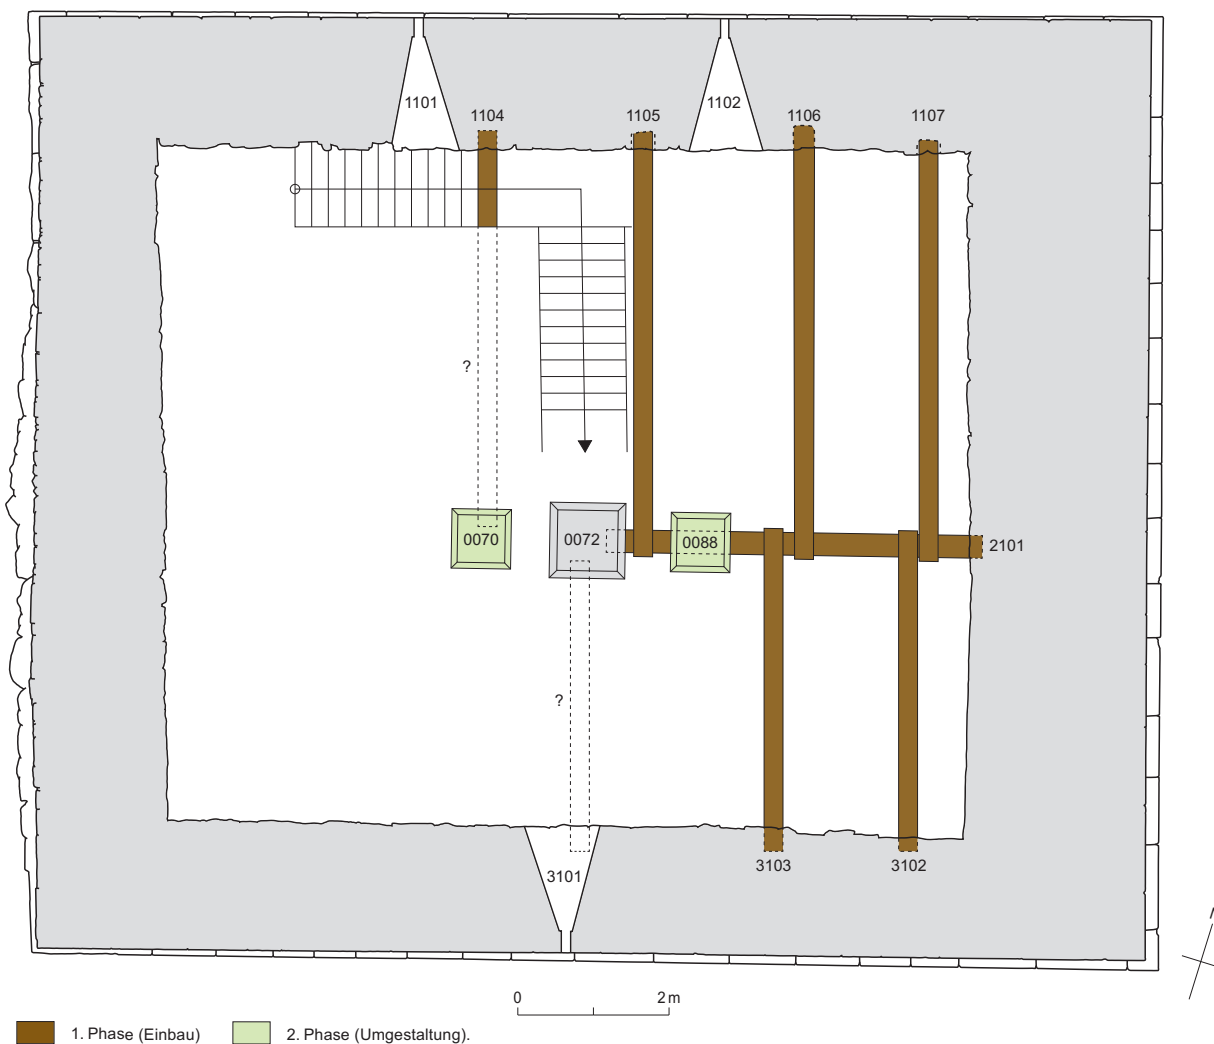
Kastelen LU. Balkenlage zum nachträglich eingefügten Zwischenboden im Erdgeschoss, Rekonstruktionsversuch. M. 1:100.
